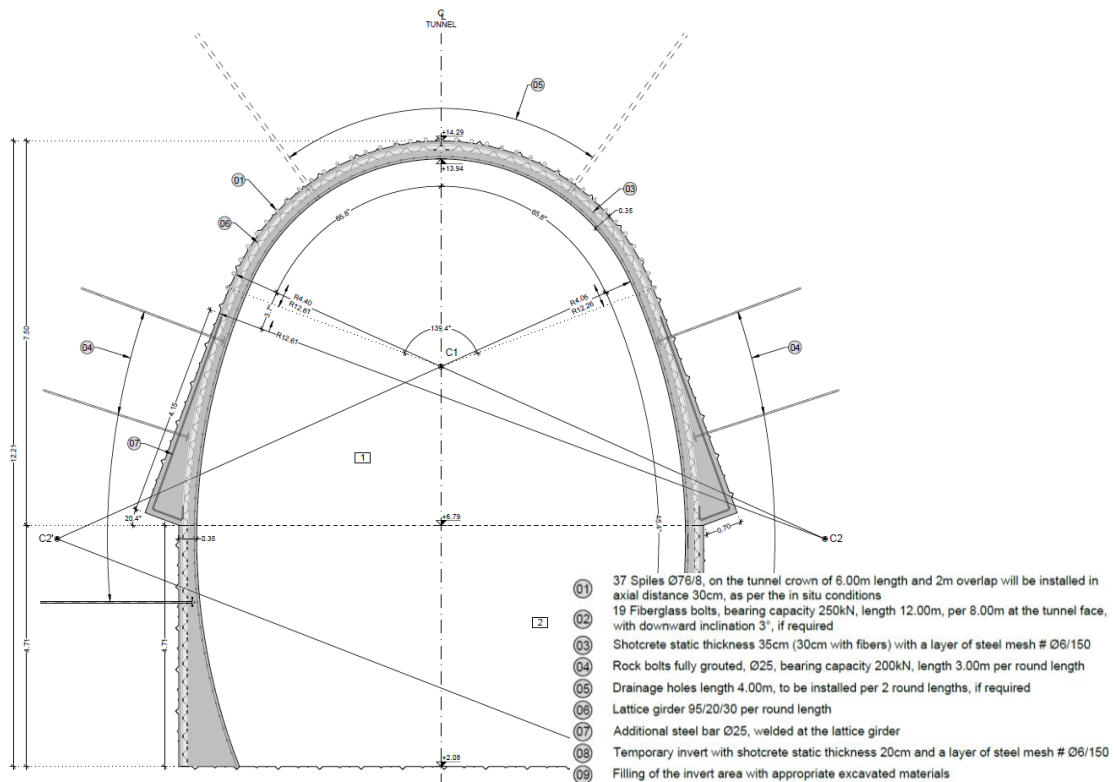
Escavação e Suporte Inicial do Túnel de Alargamento
